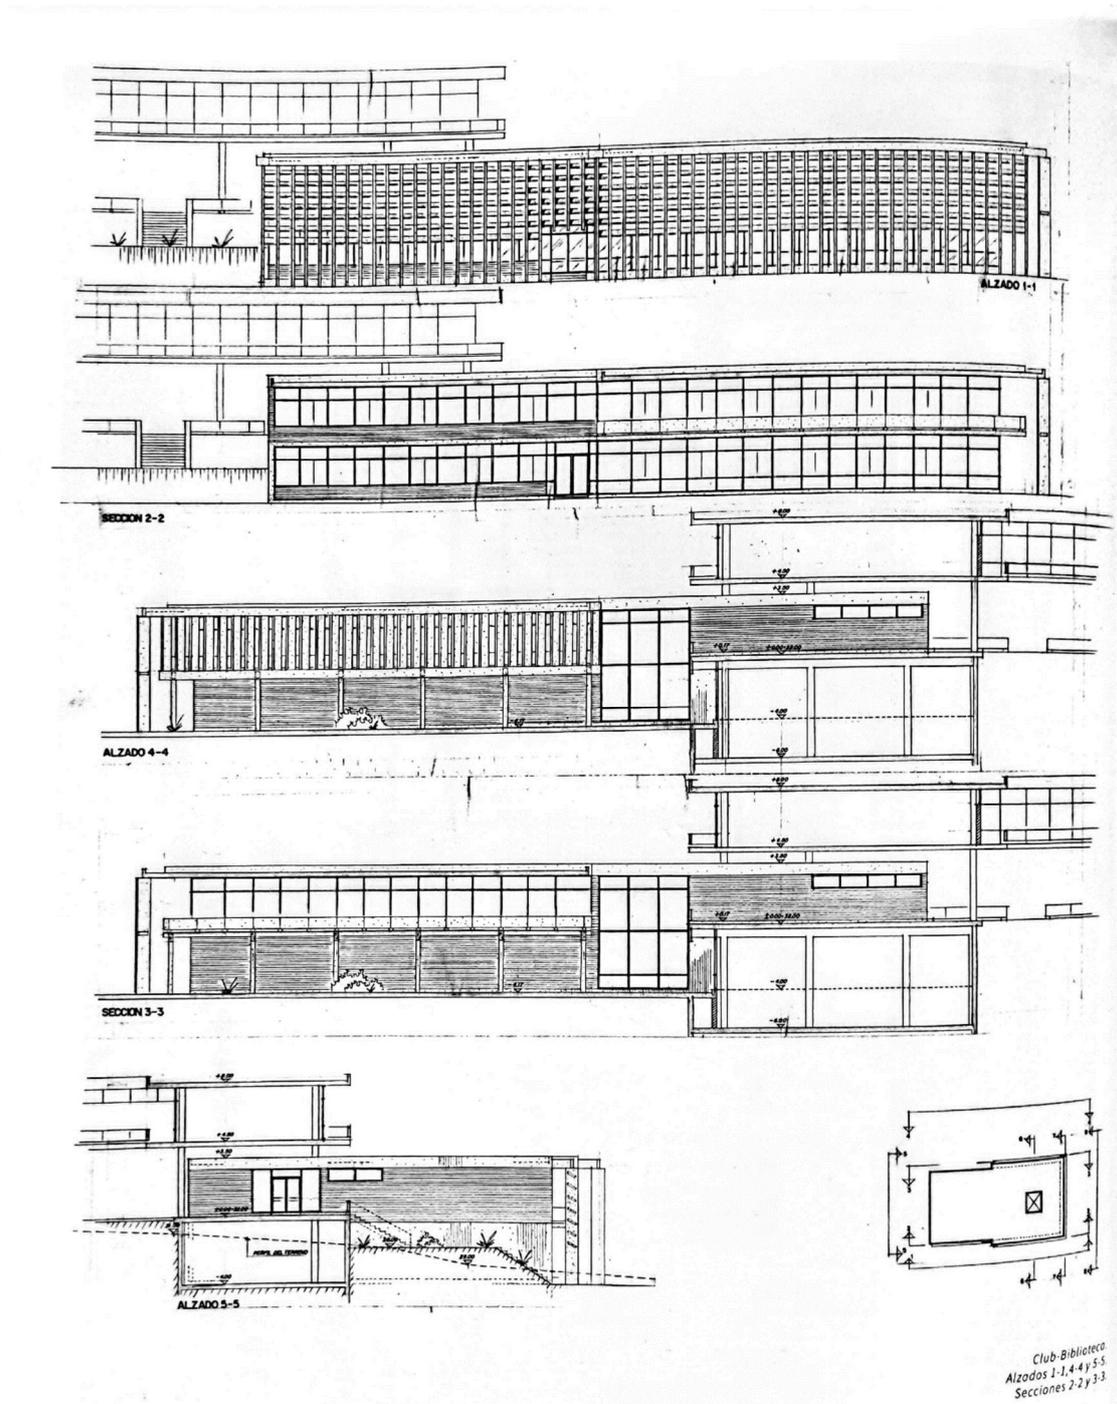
Alzados Sureste y Noroeste con protecciones y sin protecciones. Alzado Suroeste del Club-Biblioteca.
